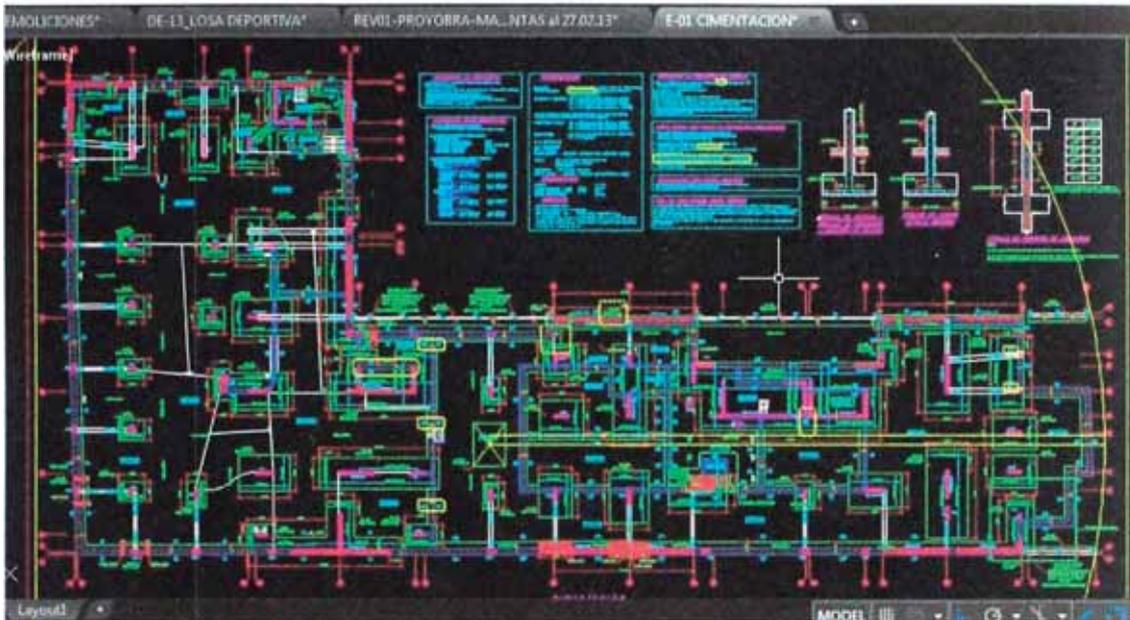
Plano de cimentación (inc. Torre grúa)
